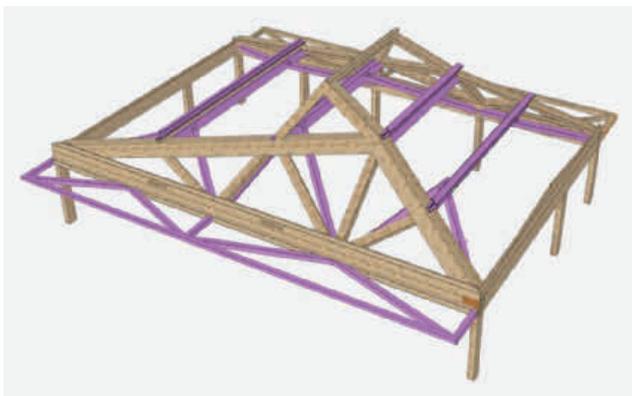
Sprengwerk mit horizontalen Fachwerken
